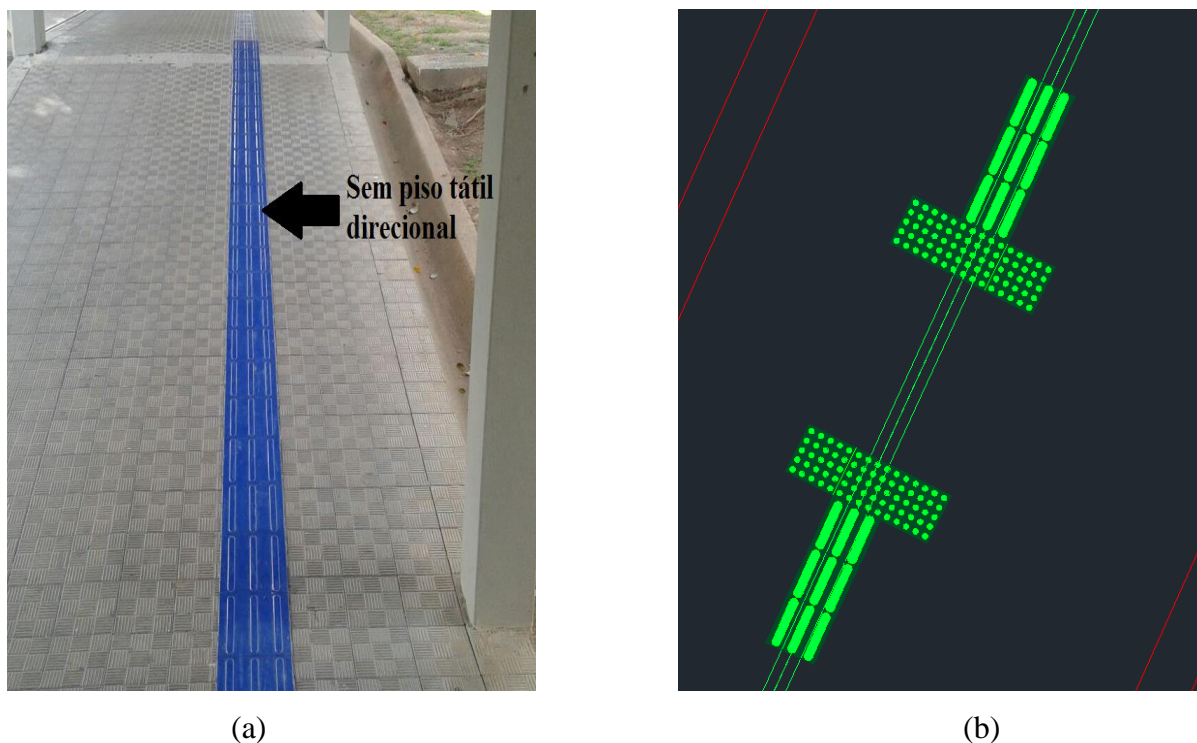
Instalação do piso tátil placa na rampa. a - Piso tátil atual. b - Projeto piso tátil.
